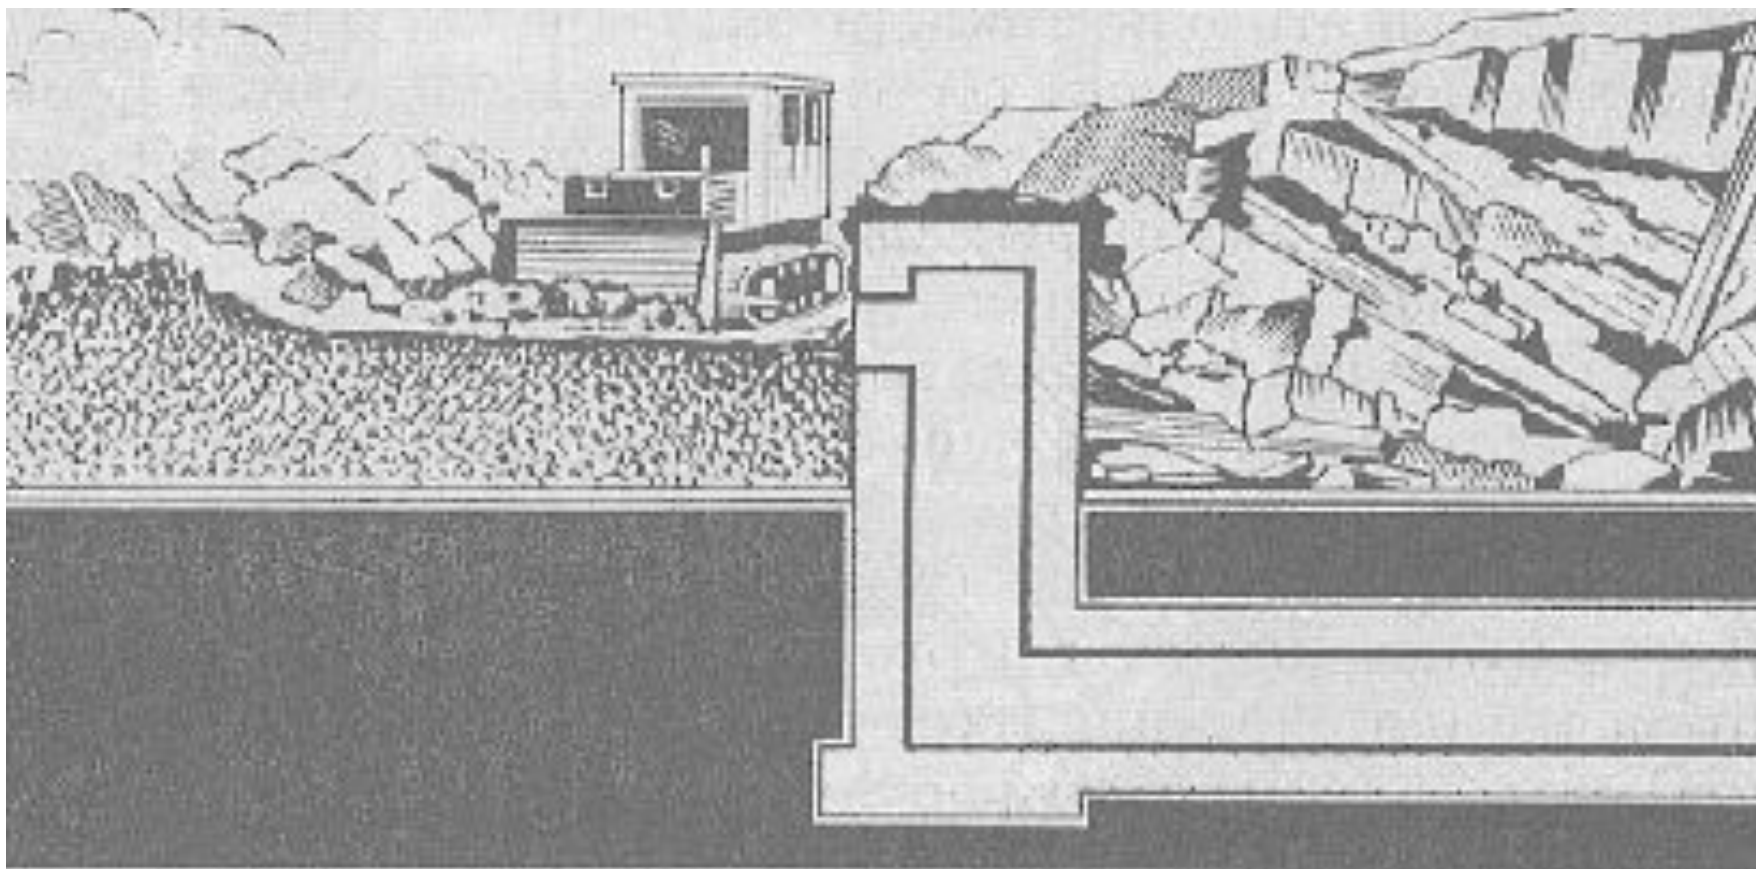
Вскрытие убежища путём пробивки отверстия в перекрытии
